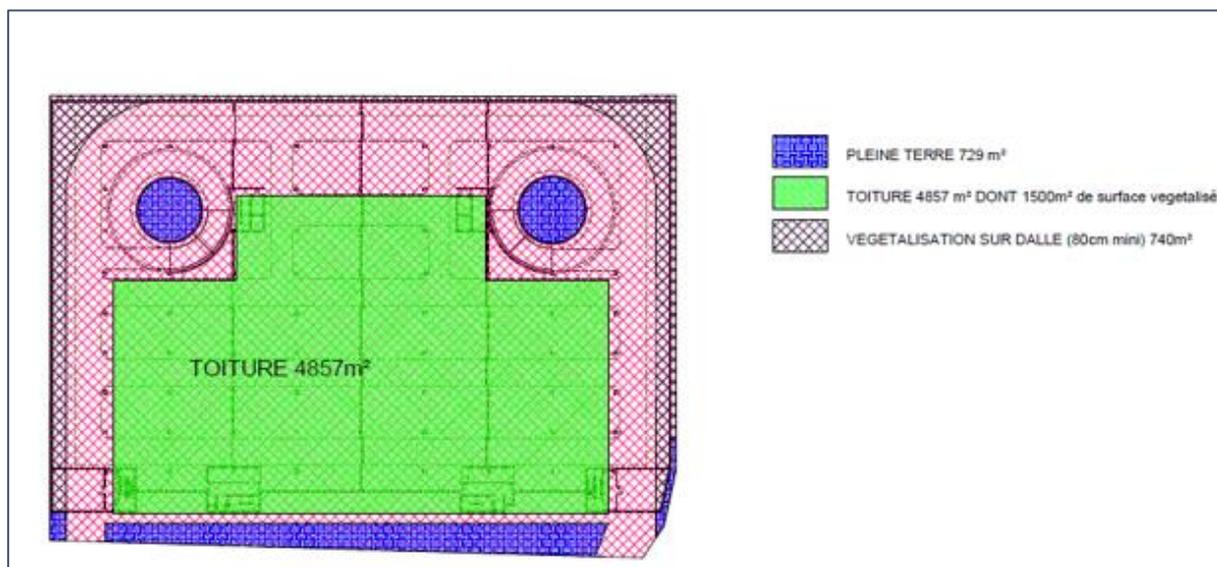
Plan des espaces verts (source : ENIA Architectes)
